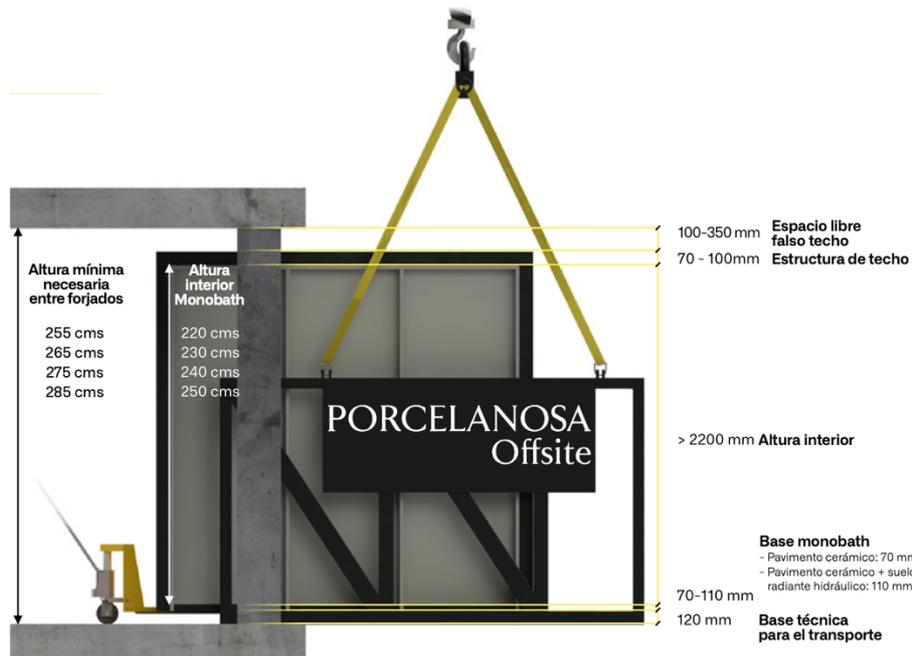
Cotas relevantes para la instalación de los módulos.
